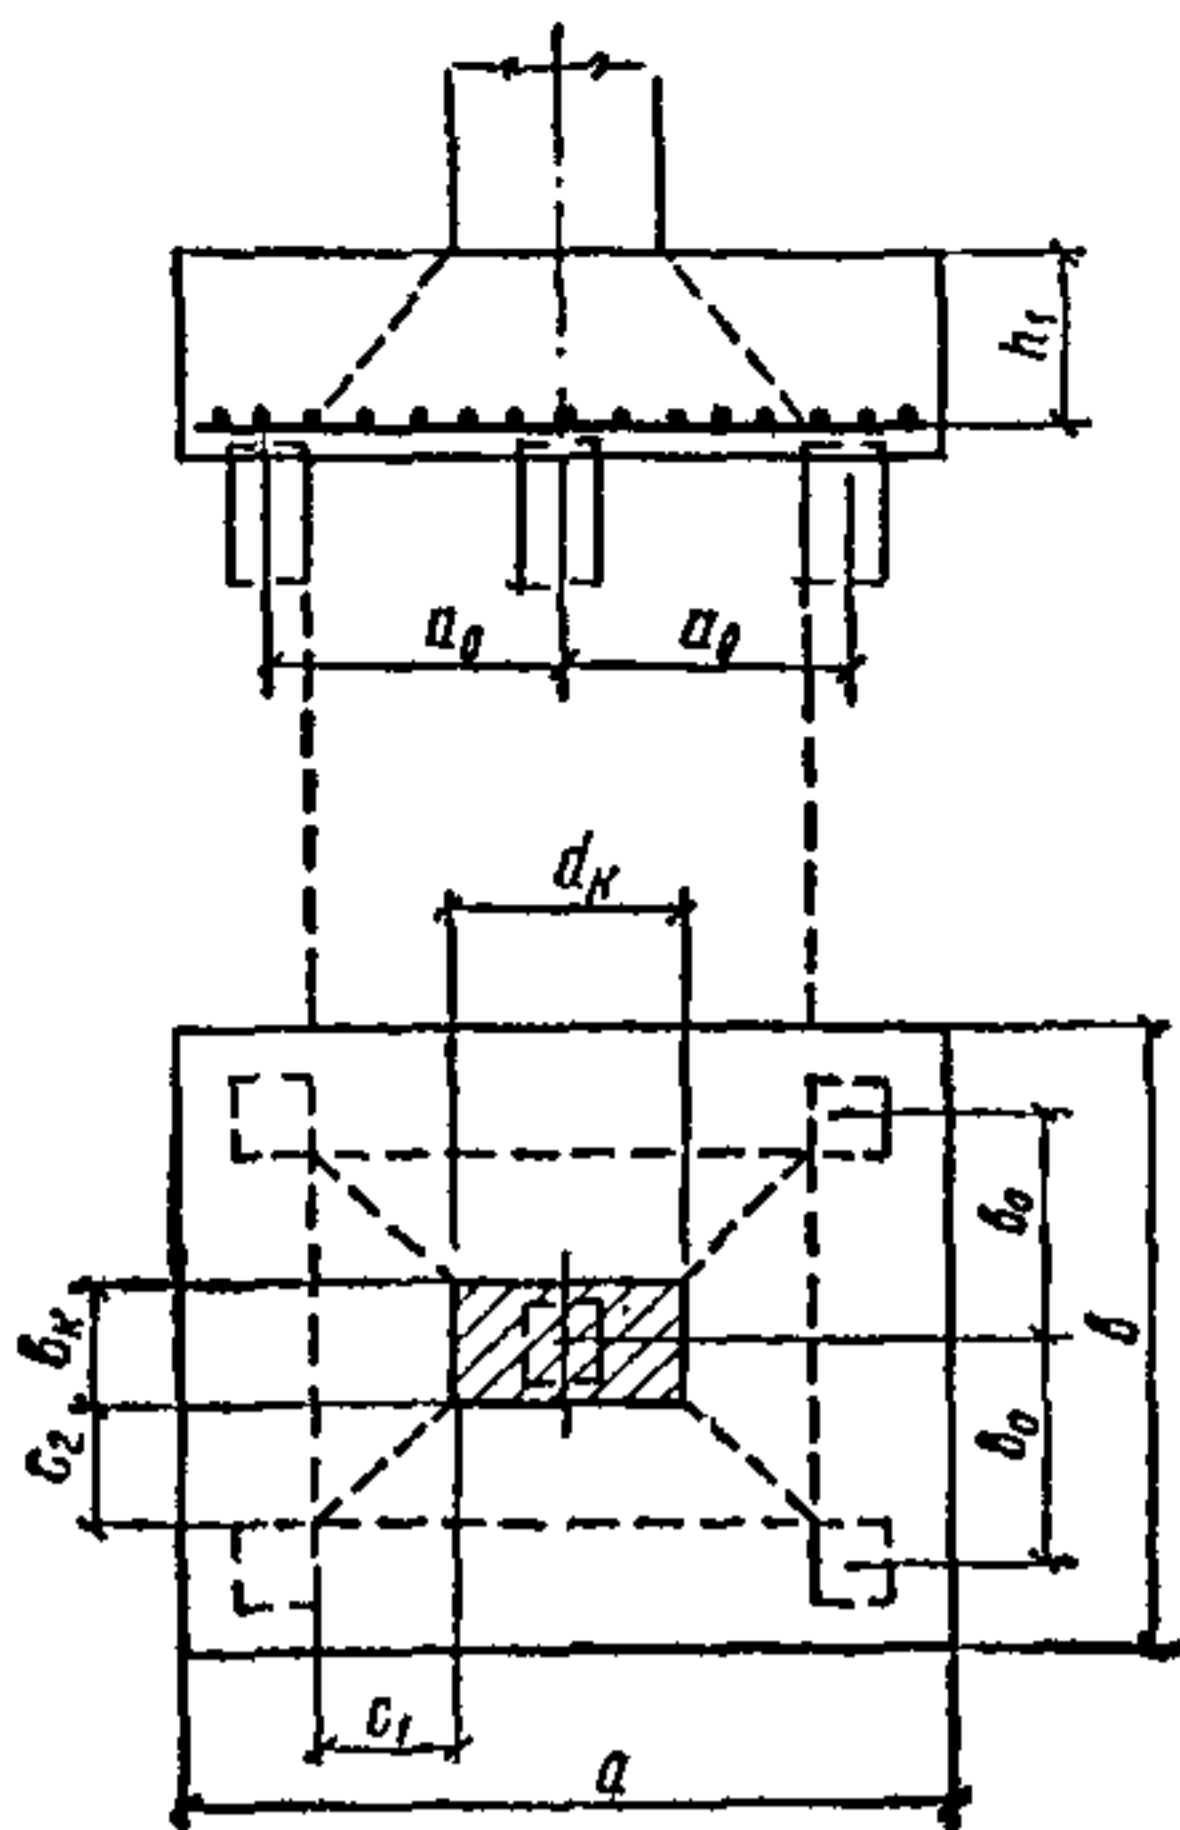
Схема образования пирамиды продавливания при монолитной железобетонной колонне
